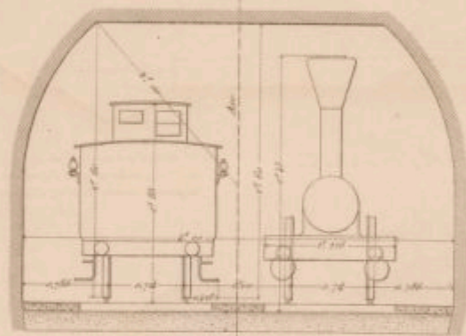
Coupe en travers par l'axe d'un ouvrage d'art.
